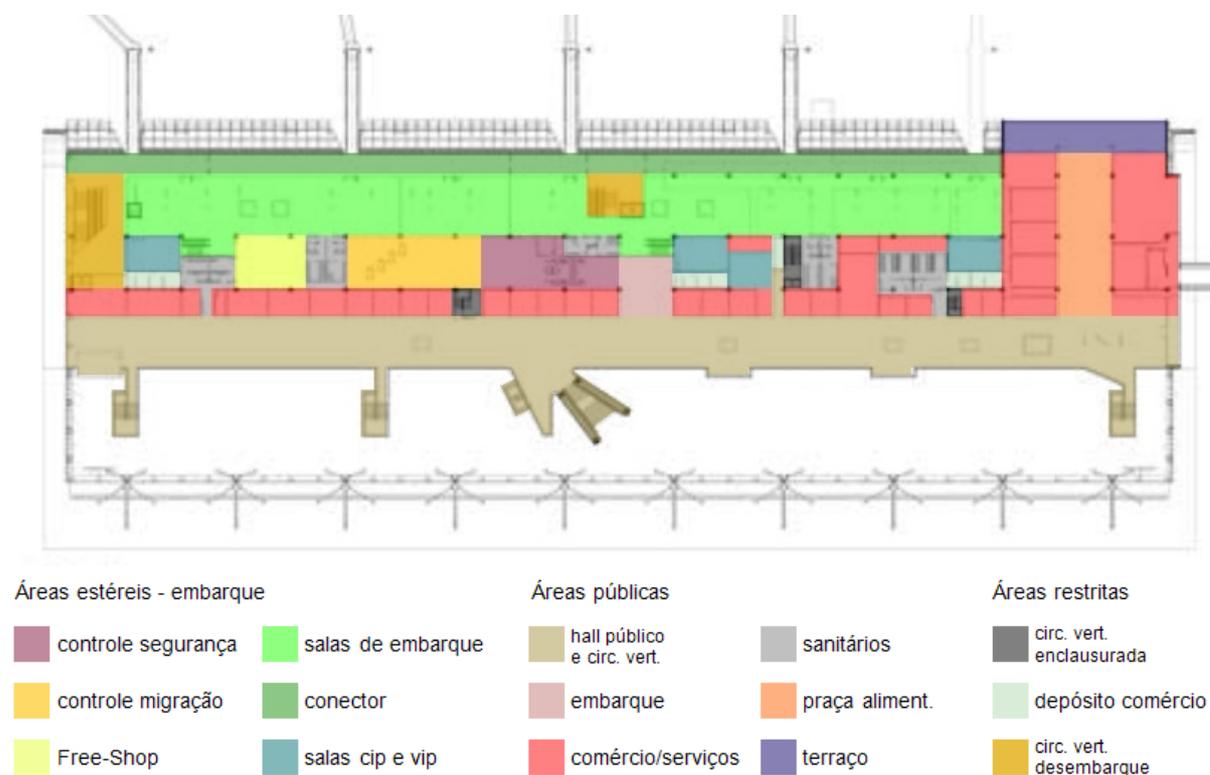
Planta do primeiro pavimento (mezanino)
